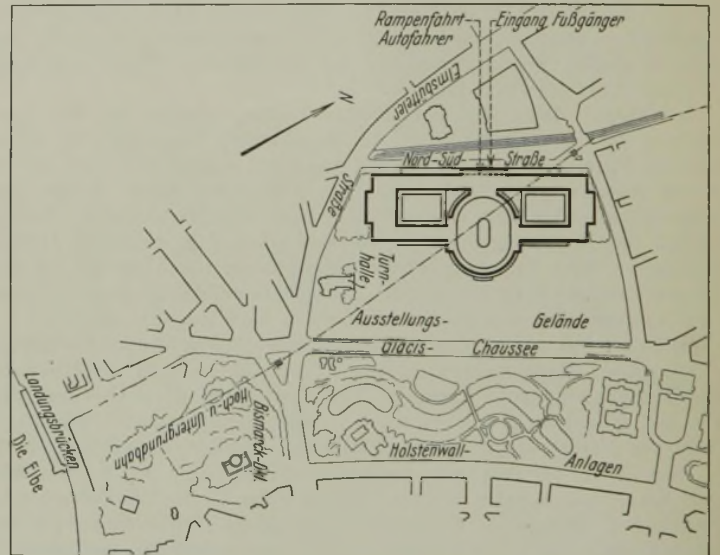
Lageplan. Entwurf Erich zu Putlitz.
